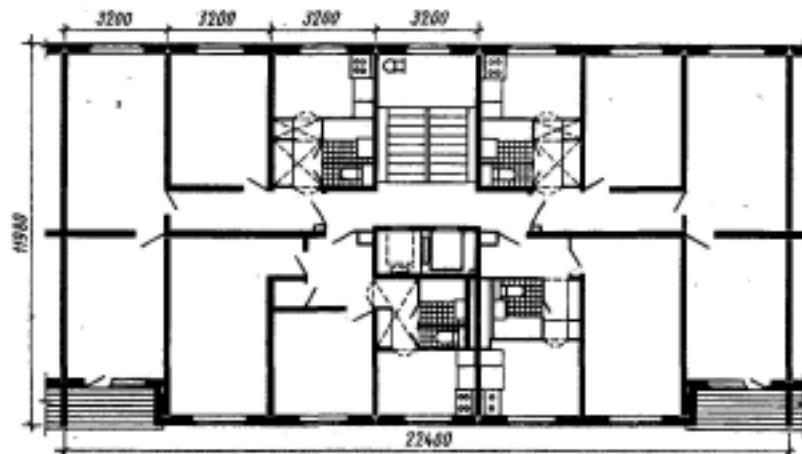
Первый крупнопанельный 12-этажный жилой дом на ул. Чкаловая в Москве. План секции
